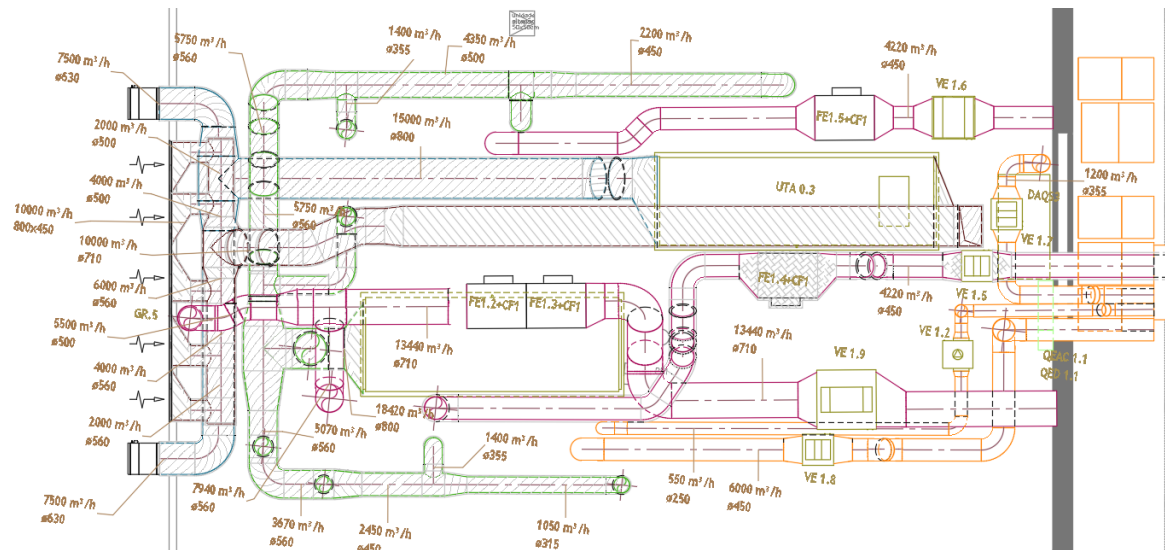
Projeto da área técnica interior do piso 1 do restaurante
